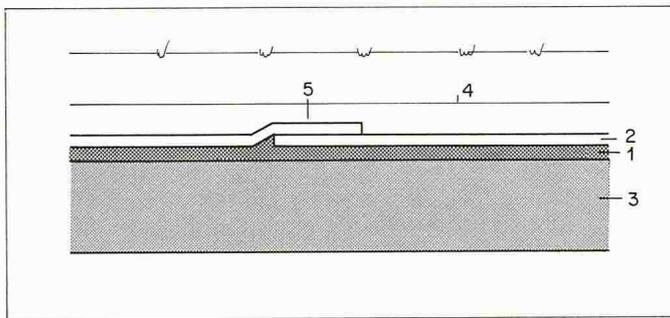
Vollflächige Verklebung von Kunststoffdichtungsbahnen. (1) Hohlräumfüllender Kleber, z.B. Zweikomponenten-PU; (2) Kunststoffdichtungsbahn; (3) Betondecke/Wand; (4) Schutzschicht (z.B. Schutzmörtel oder Schutzmatten); (5) Stöße überlappt oder stumpf mit Bandschweissen.
